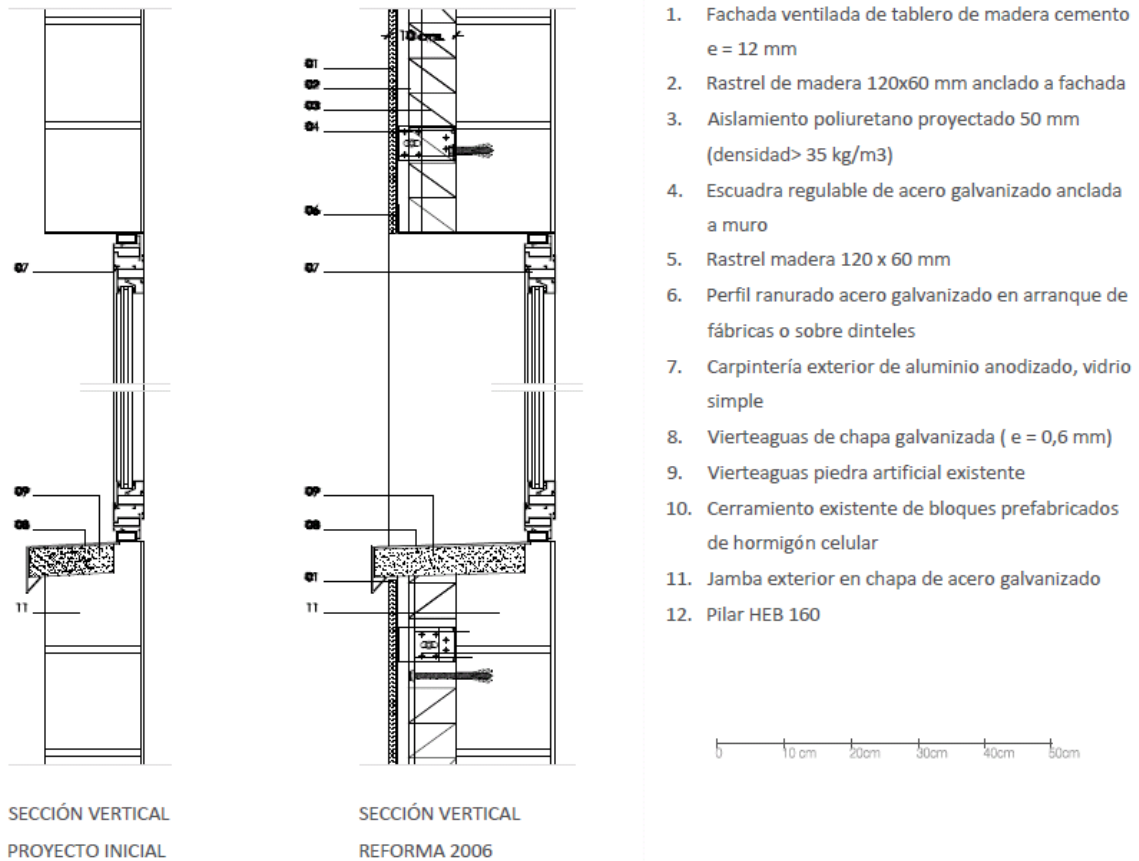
Detalles constructivos de la fachada del proyecto inicial y de la reforma del 2006 en el IES Leopoldo Cano. Fuente: Archivo Municipal de Valladolid, C 05254-3.
